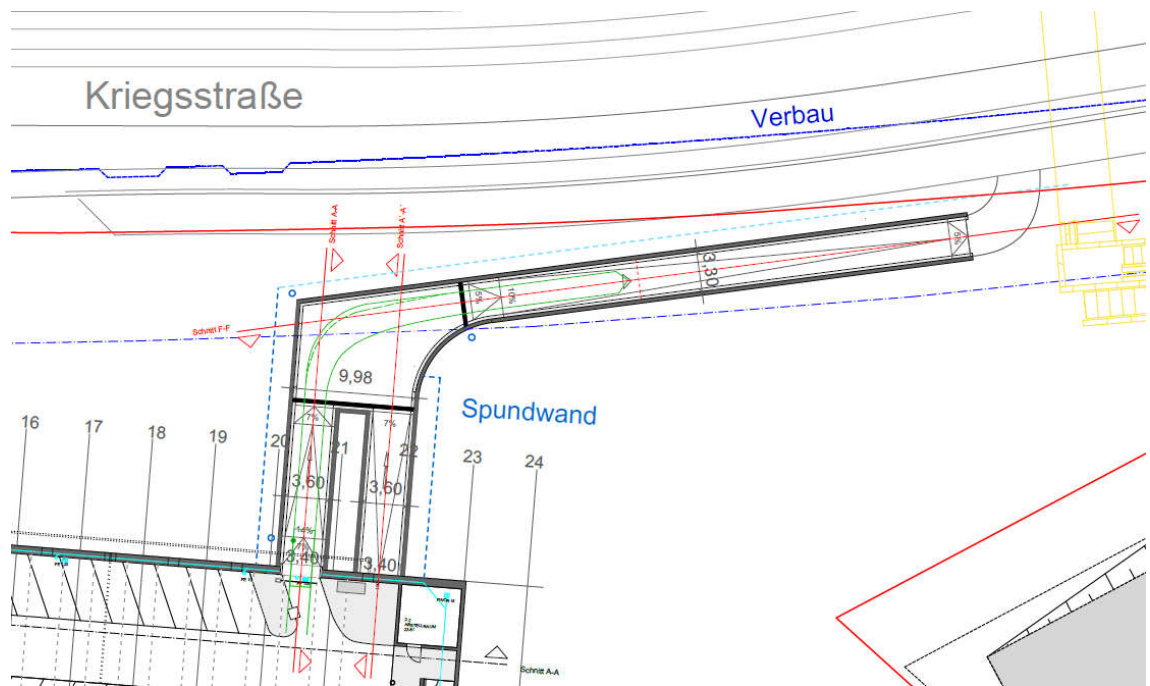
Ausfahrtsituation der geplanten Zufahrt zur Kriegsstraße
